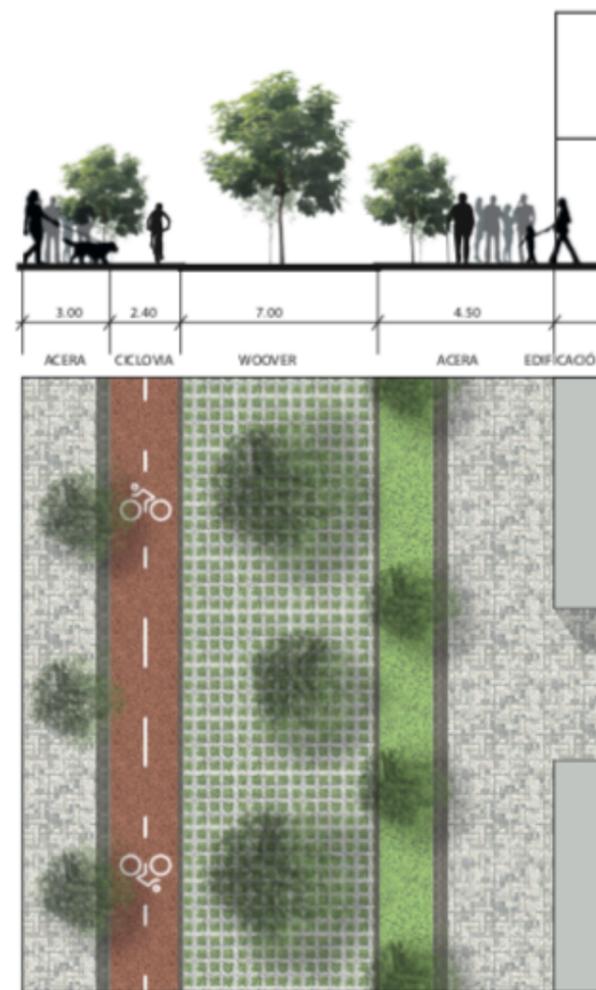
Corte calle Colimes. Tomada de Master Plan “El Batán”
